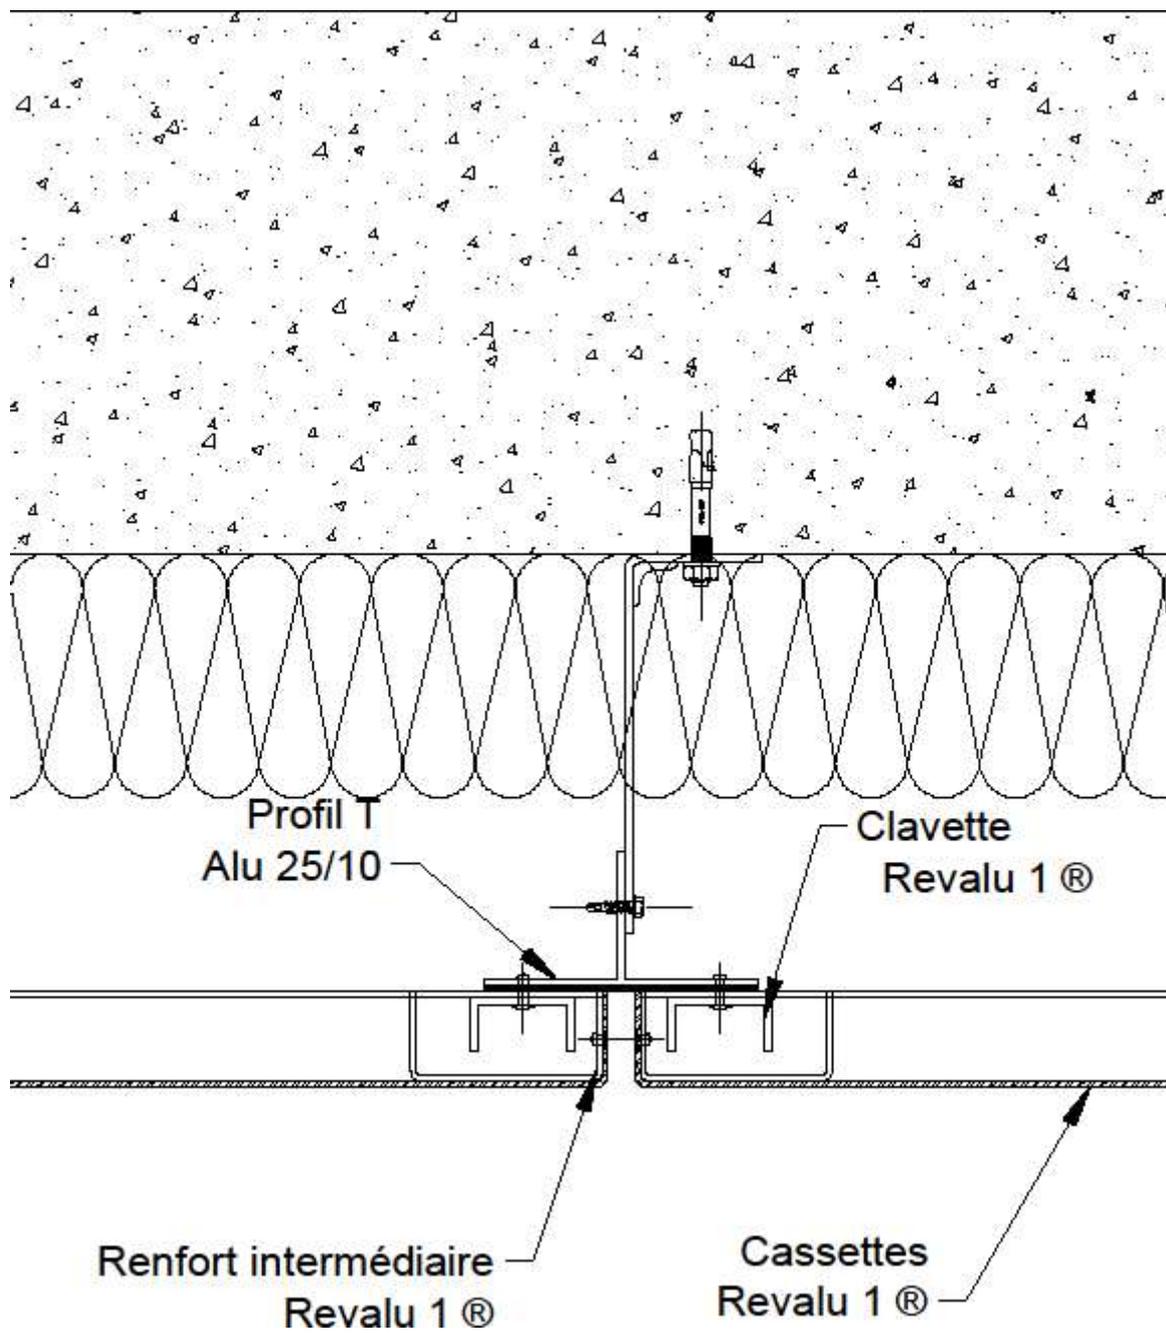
Coupe horizontale au droit du joint sur profilé T (pose verticale)
